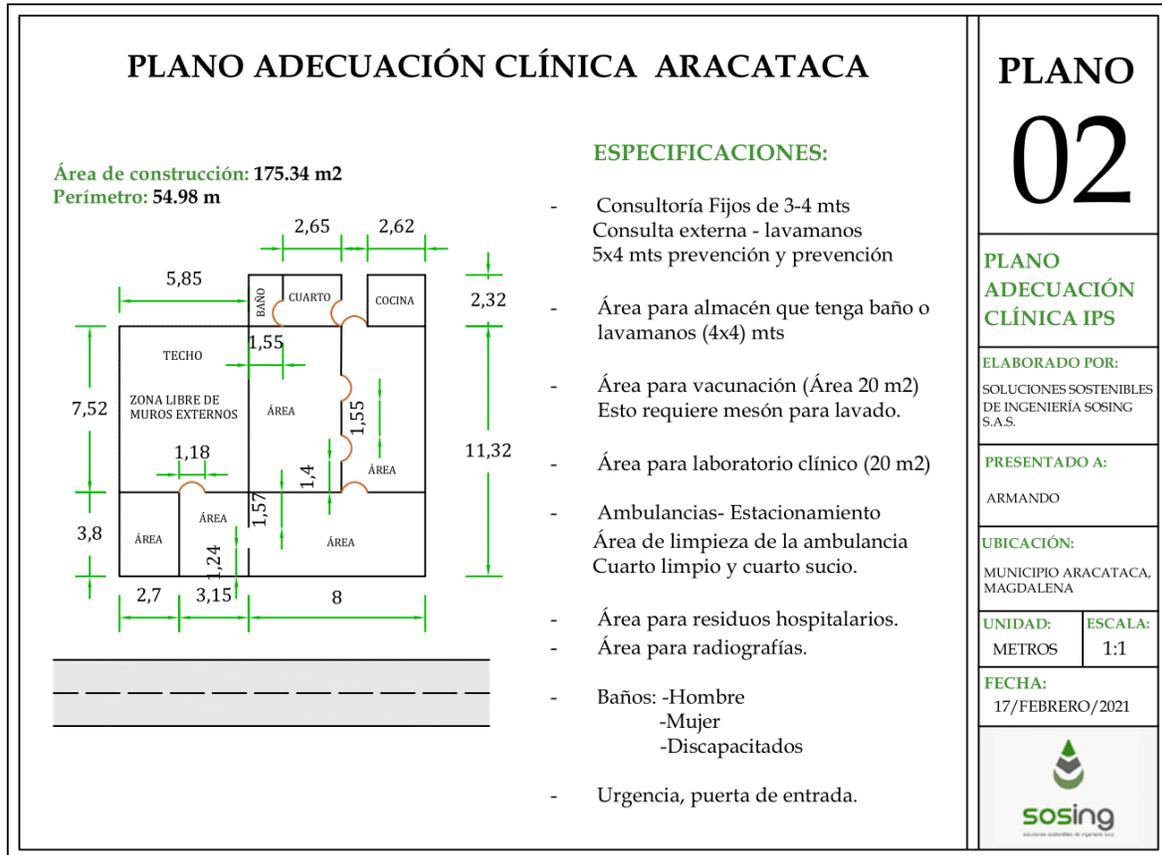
Plano Arquitectónico de Centro de Salud Existente con sus Especificaciones Técnicas.
